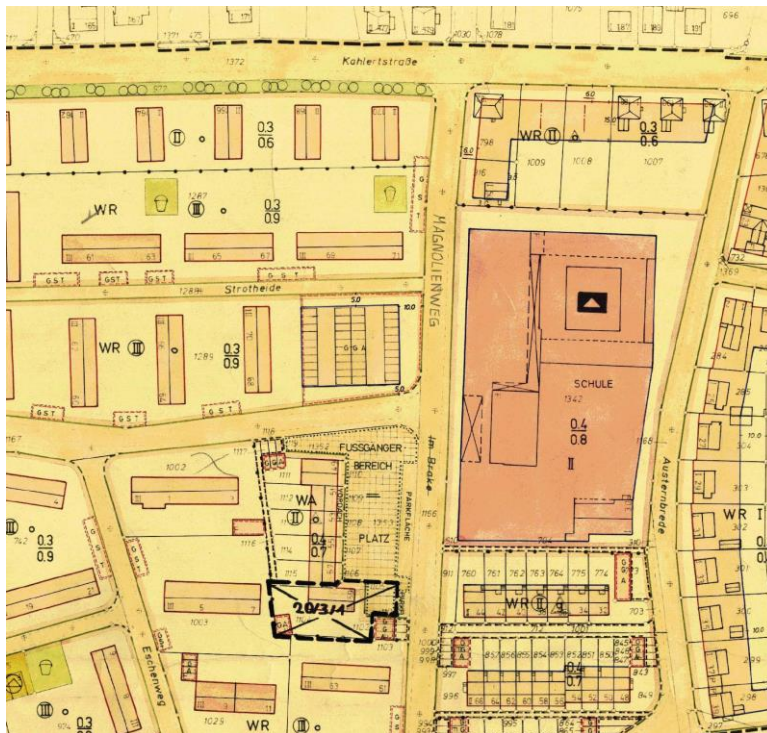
Bebauungsplan Nr. 20/3 Baugebiet zwischen Kahlertstraße, Surenhofsweg und Schlangenberg (Ausschnitt mit zentral gelegenem "Ladenzentrum", dreigeschossigem Mietwohnungsbau und freistehenden Einfamilienhäusern). Quelle: Datenbank der Stadt Gütersloh.
